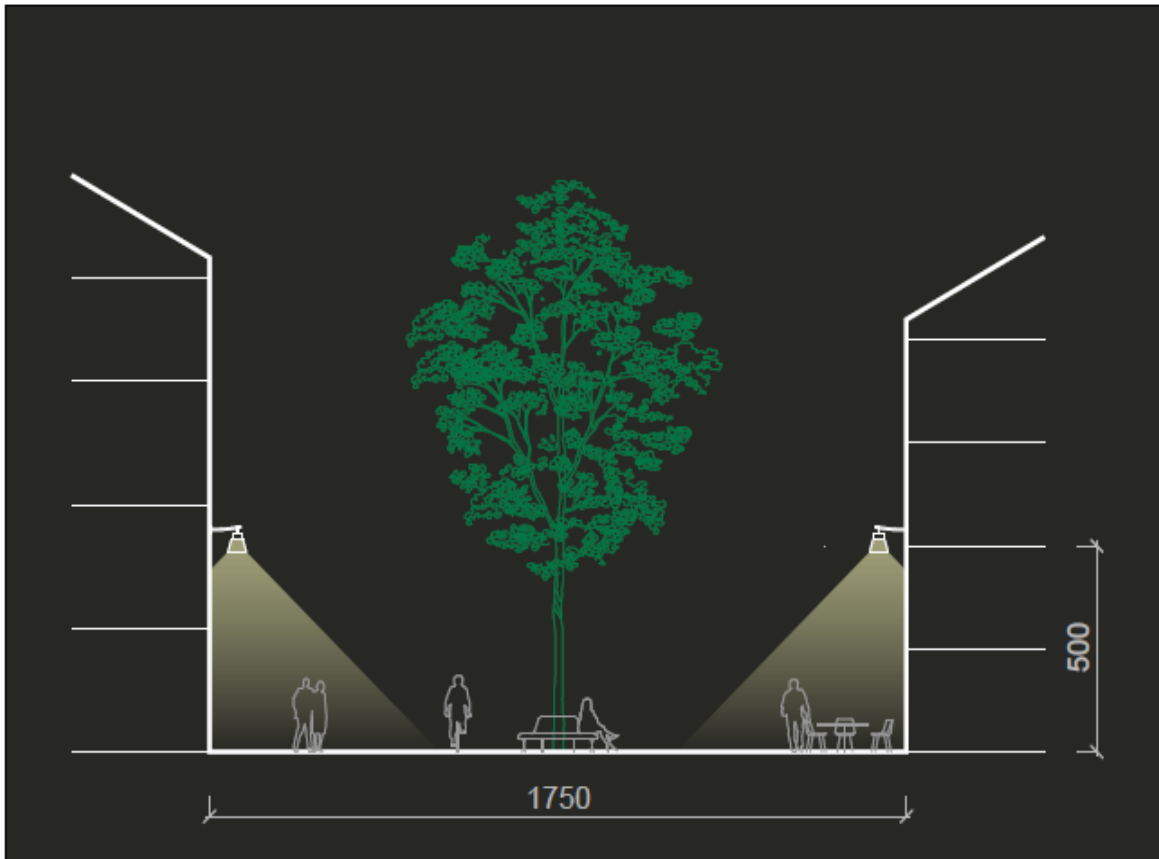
Rue du Coq d'Inde : coupe projetée. Les lanternes actuelles suspendues au centre seront remplacées par des consoles appliquées sur les façades.
